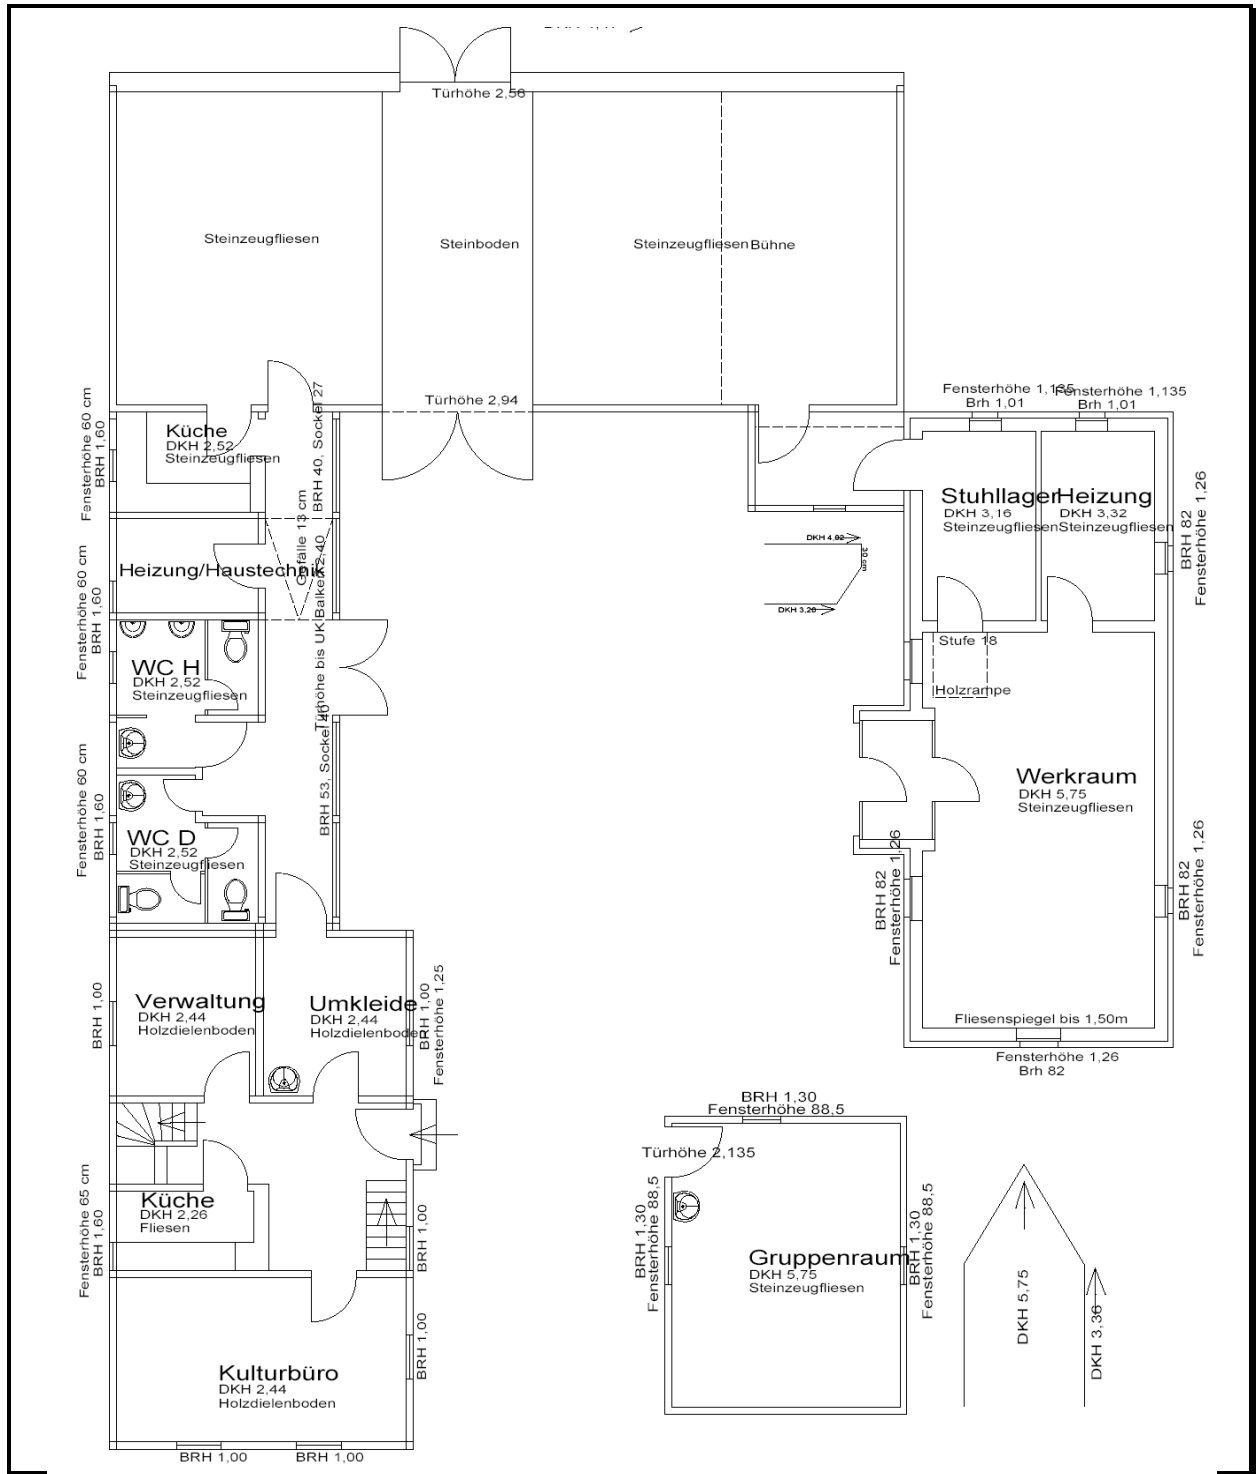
Löhrrhof: Grundriss EG
